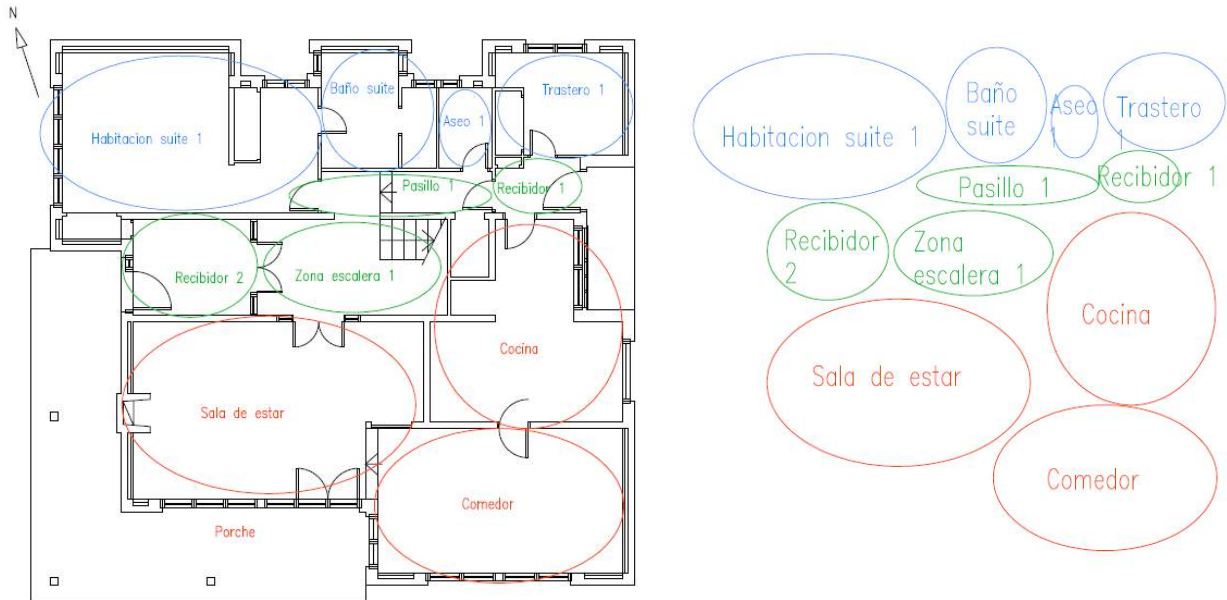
Distribución de zonas frías / calientes en planta baja, proyecto original.
